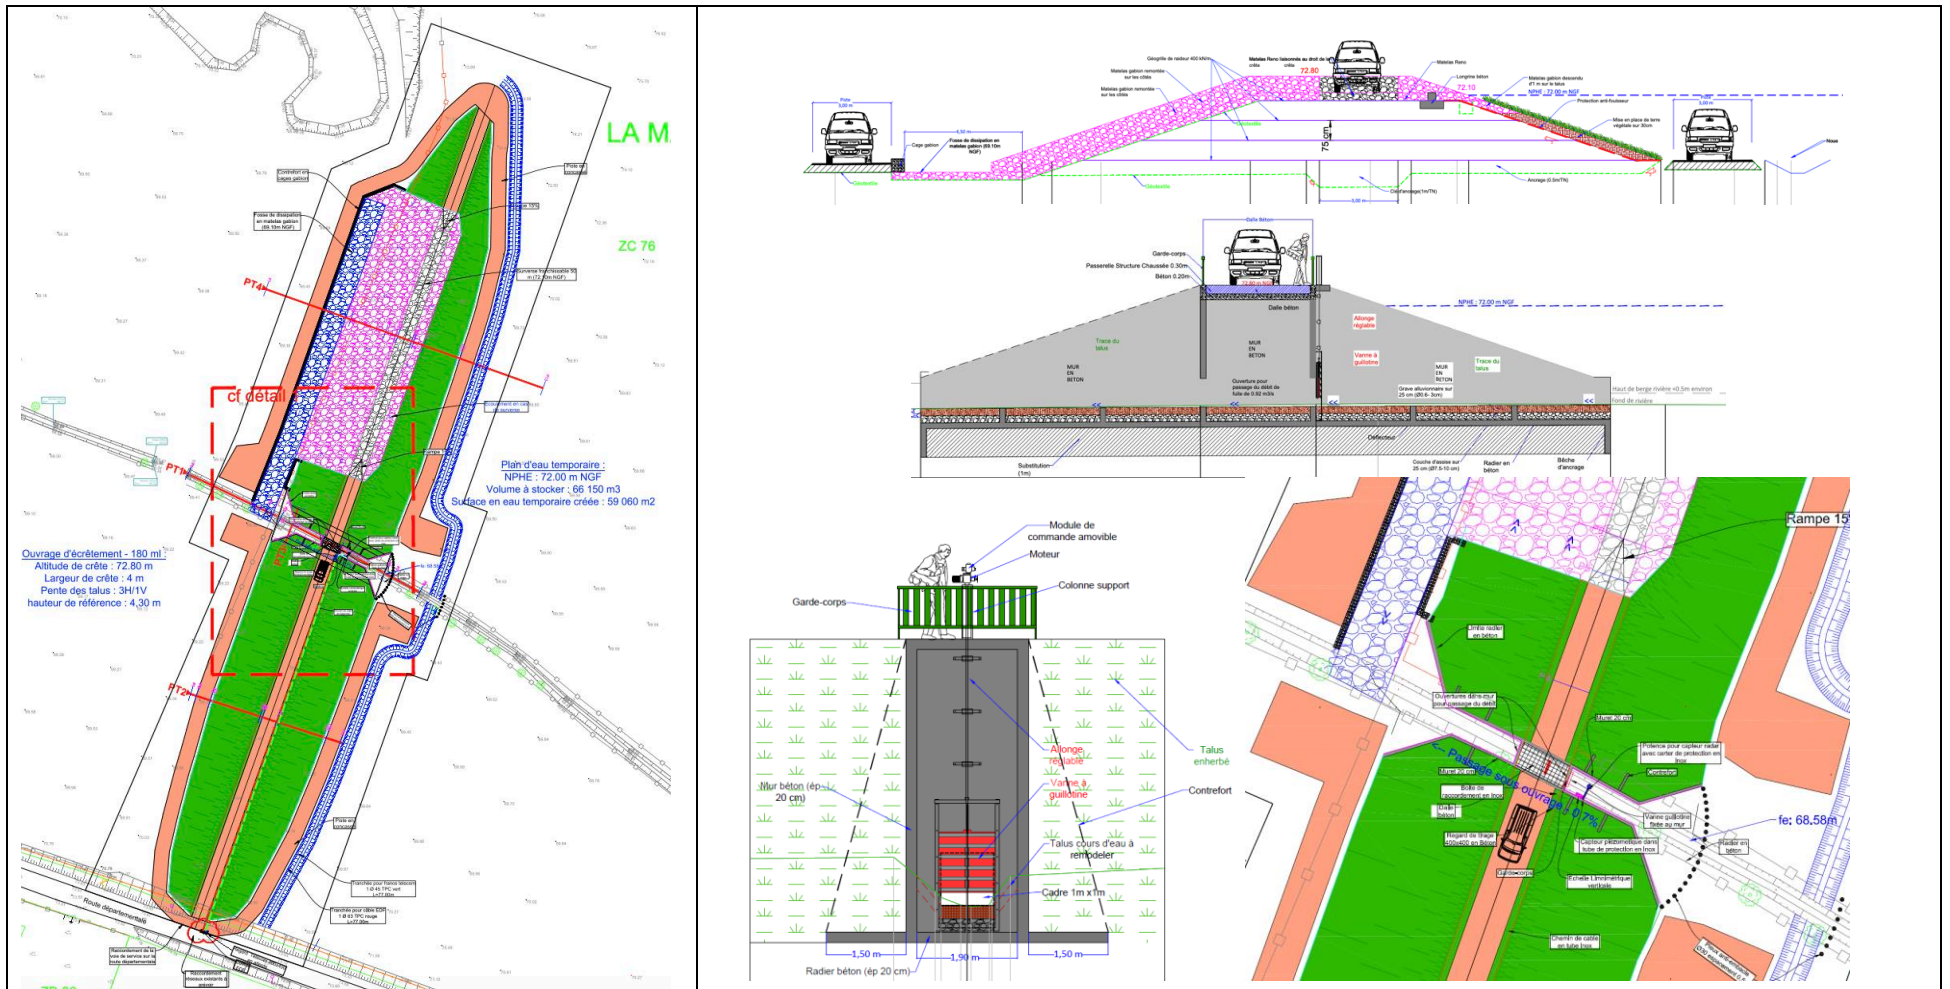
Plans et coupes de l'ouvrage de Beaugies-sous-bois (PRO – indice E)
